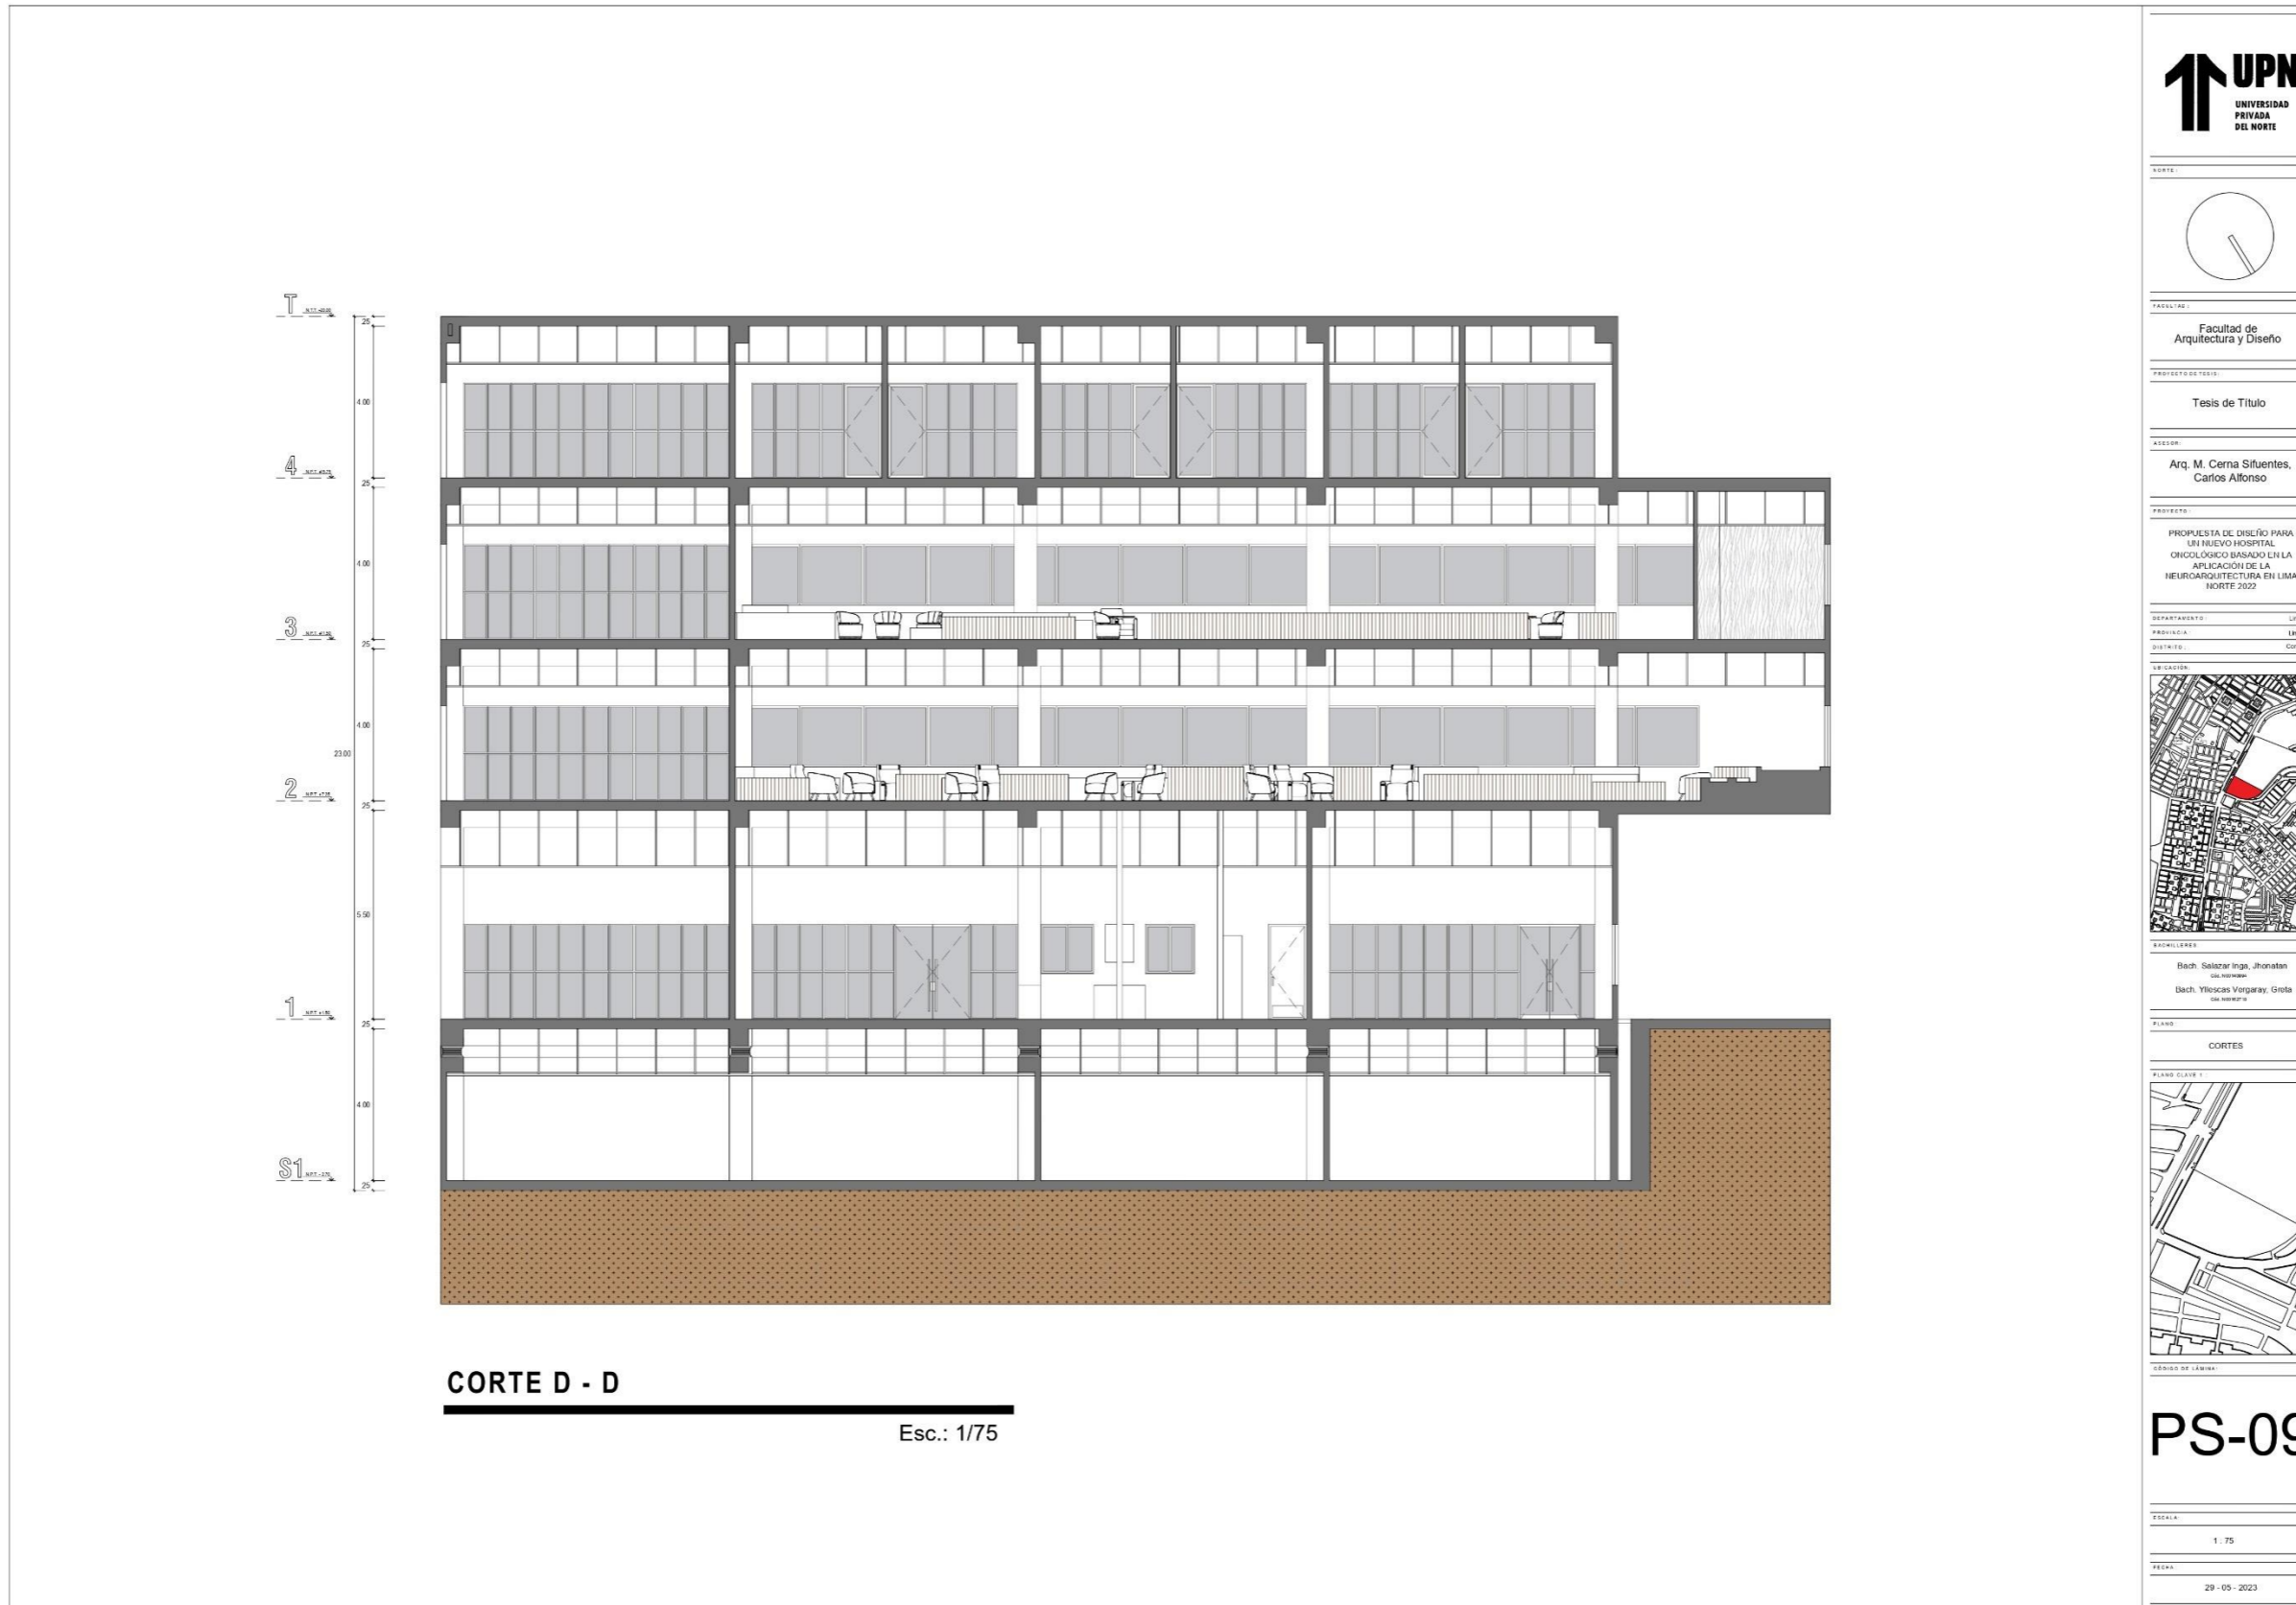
Arquitectura – Cortes N°4 del sector cuadrante Esc: 1/75 (Fuente: Elaboración propia de los coautores)
